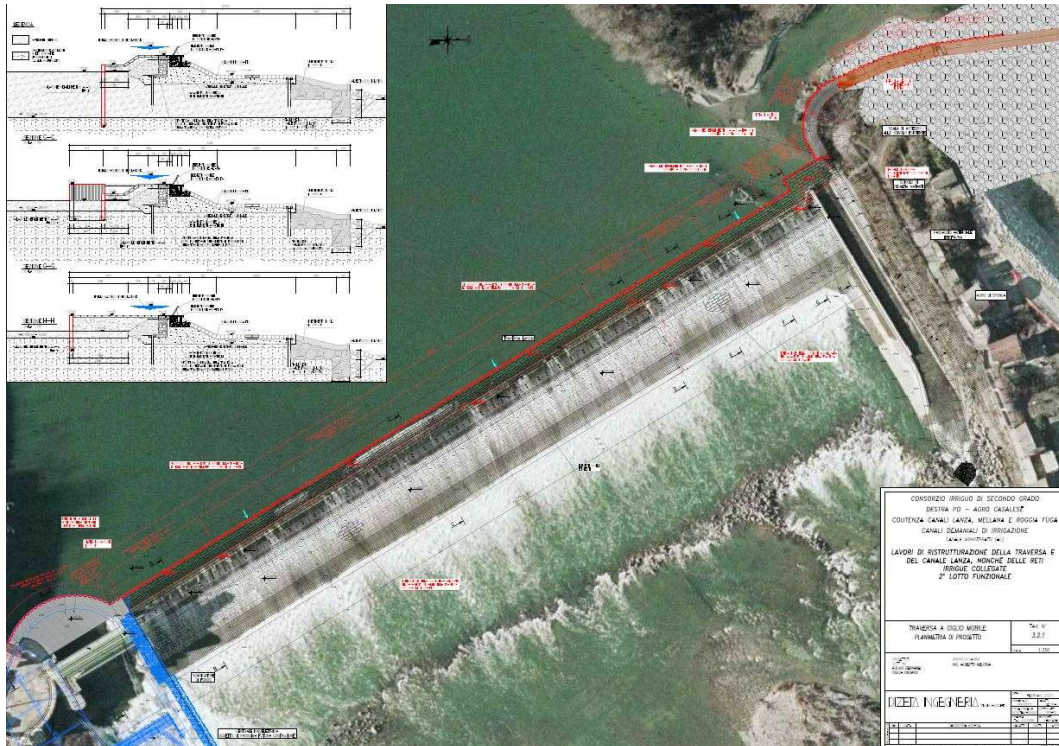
Planimetria degli interventi di progetto sulla traversa Lanza a ciglio mobile
